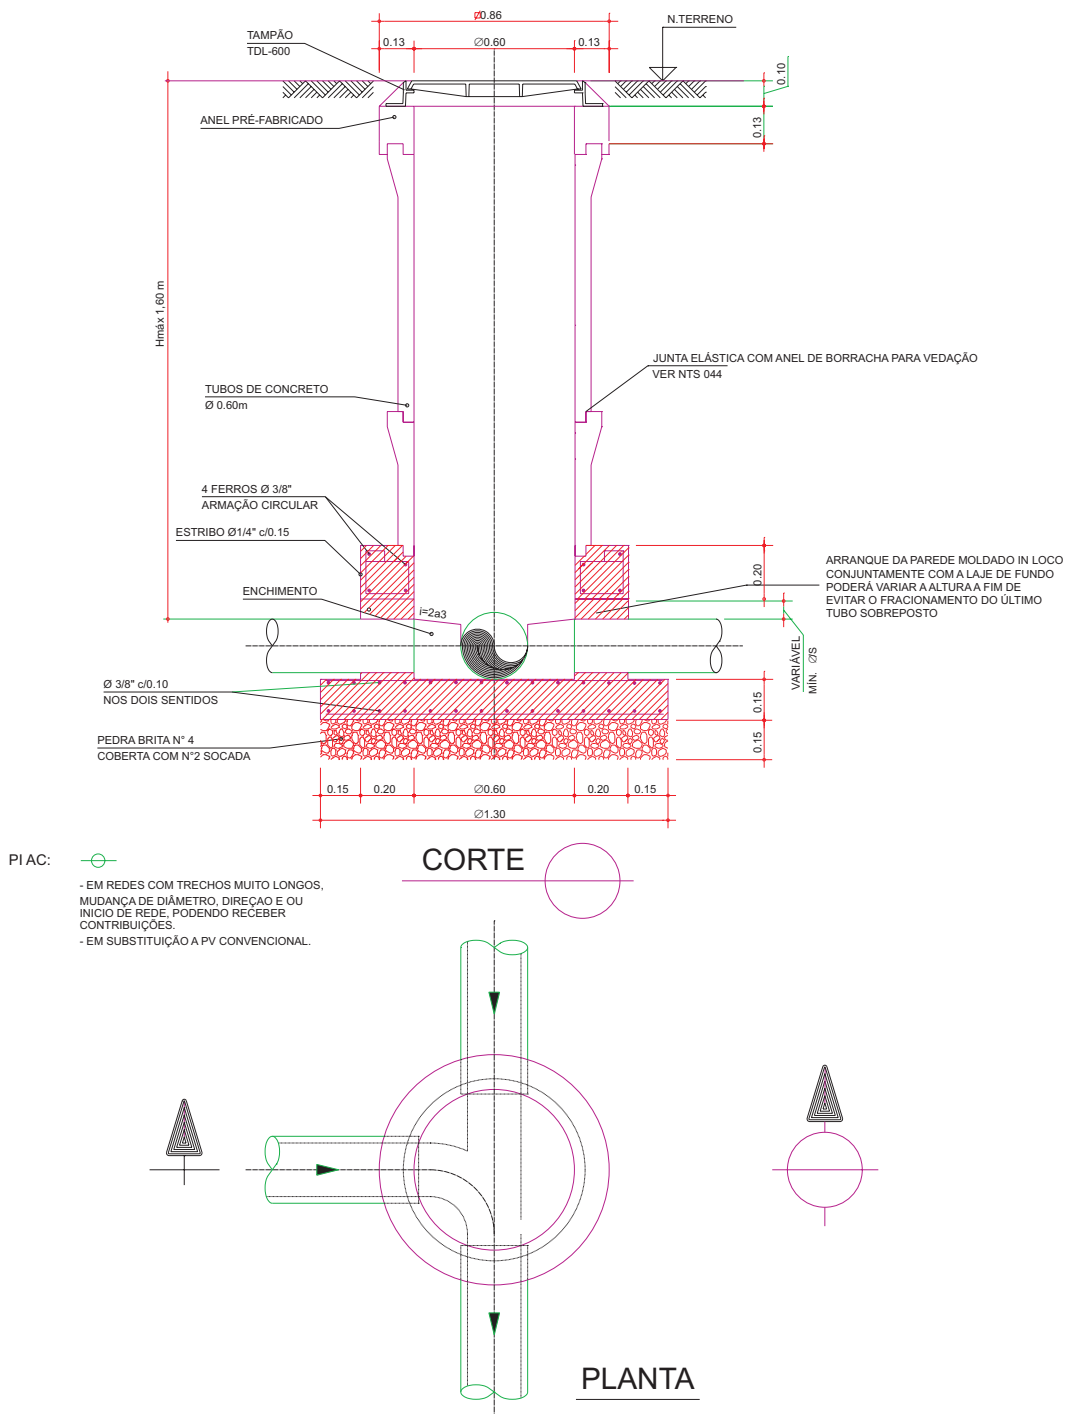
Poço de inspeção em tubos de concreto, ponta e bolsa, com junta elástica. (Sabesp, 2006)
